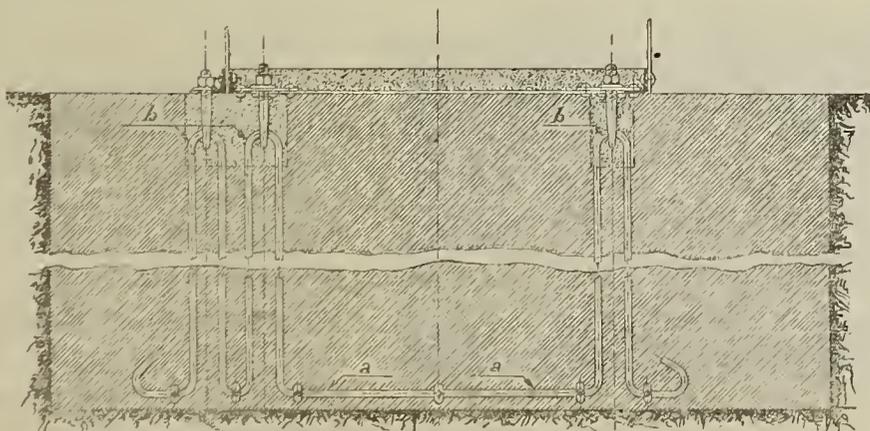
Coupe transversale de la fondation d'un poteau d'angle.
